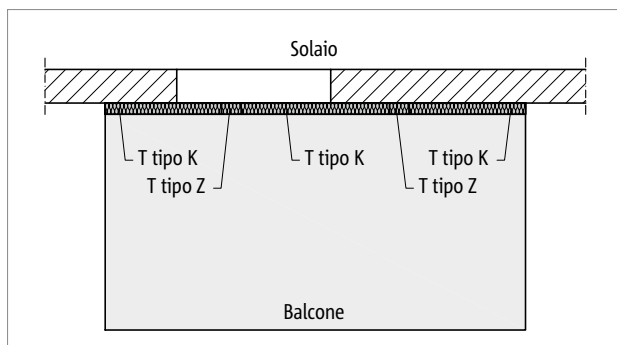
Schöck Isokorb® T tipo Z, K: balcone a sbalzo
